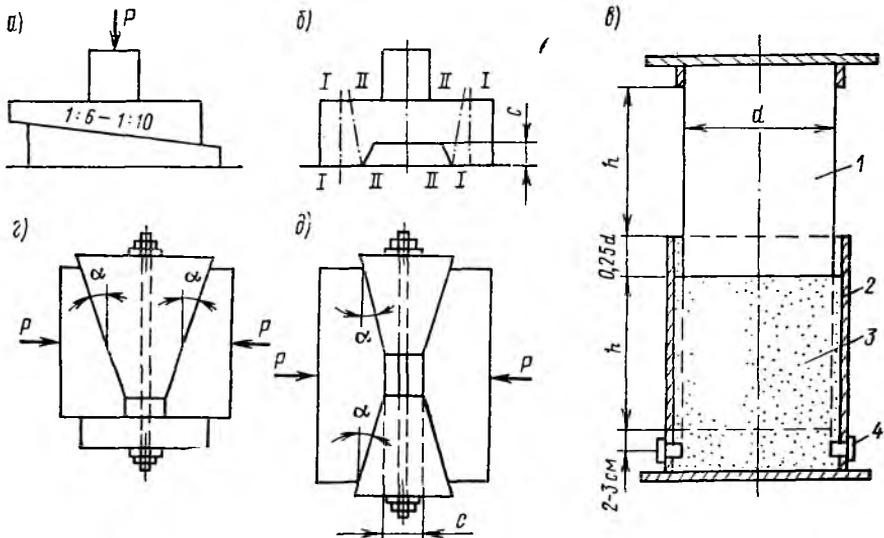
Приборы для раскружаливания забетонированных конструкций
